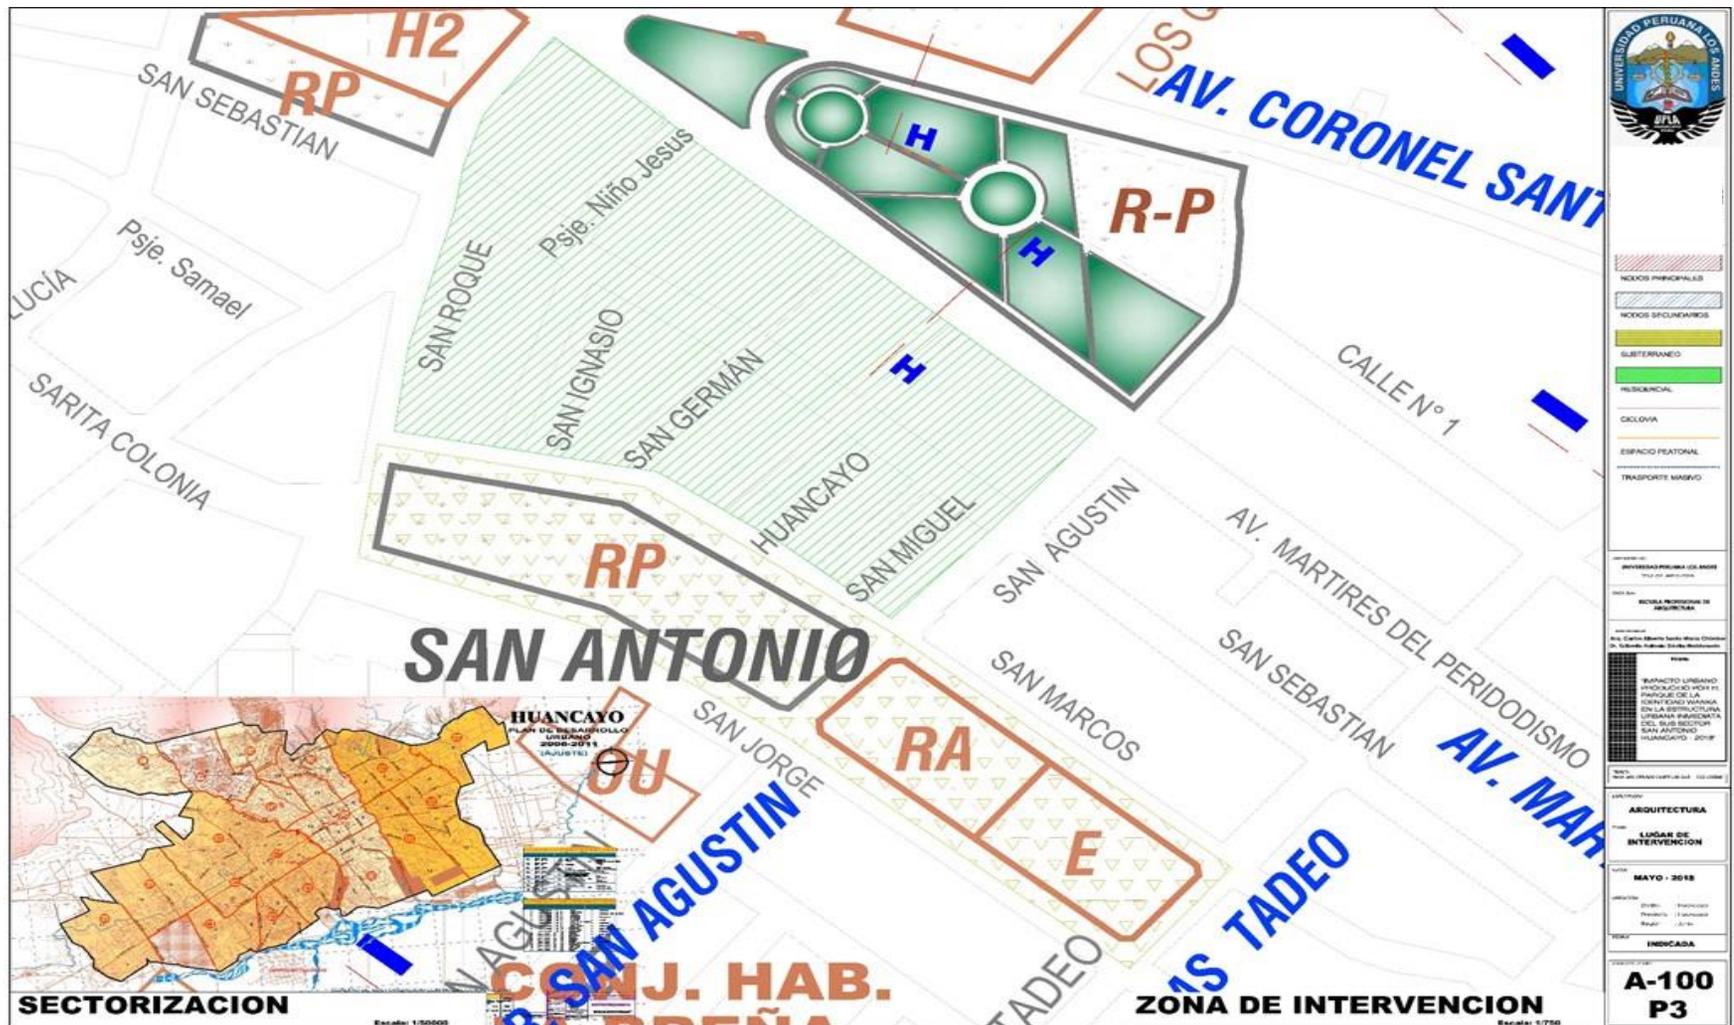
Plano de zona de intervención. Fuente. Propia.
